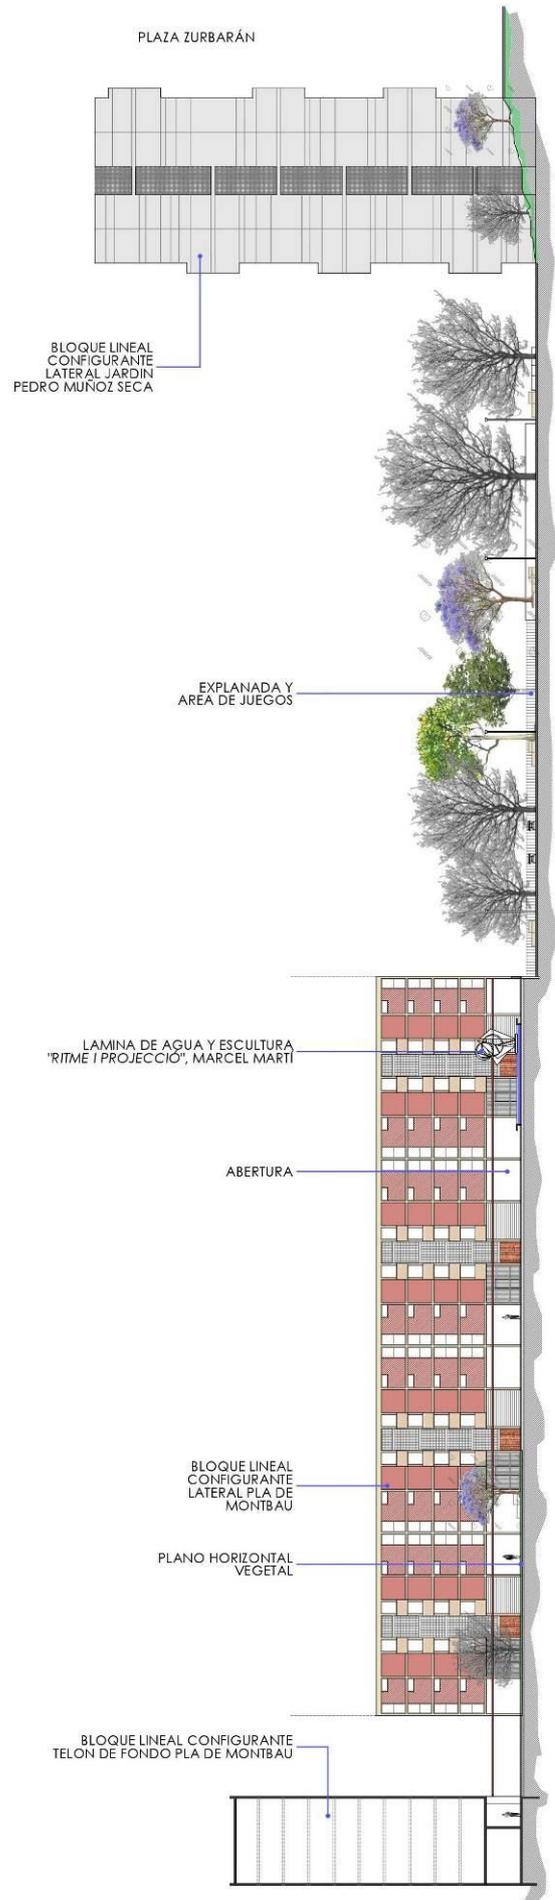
y 3.23 Cortes Transversales A y B de Pla de Montbau. Se puede apreciar con mayor claridad como las fachadas adquieren mayor protagonismo de los planos verticales que configuran el espacio público.
